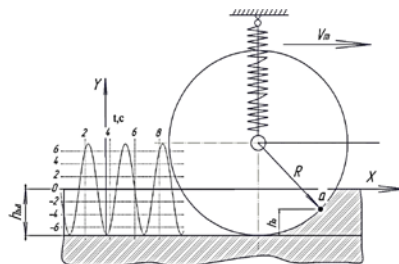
Схема движения виброкатка при формировании профиля борозды:
